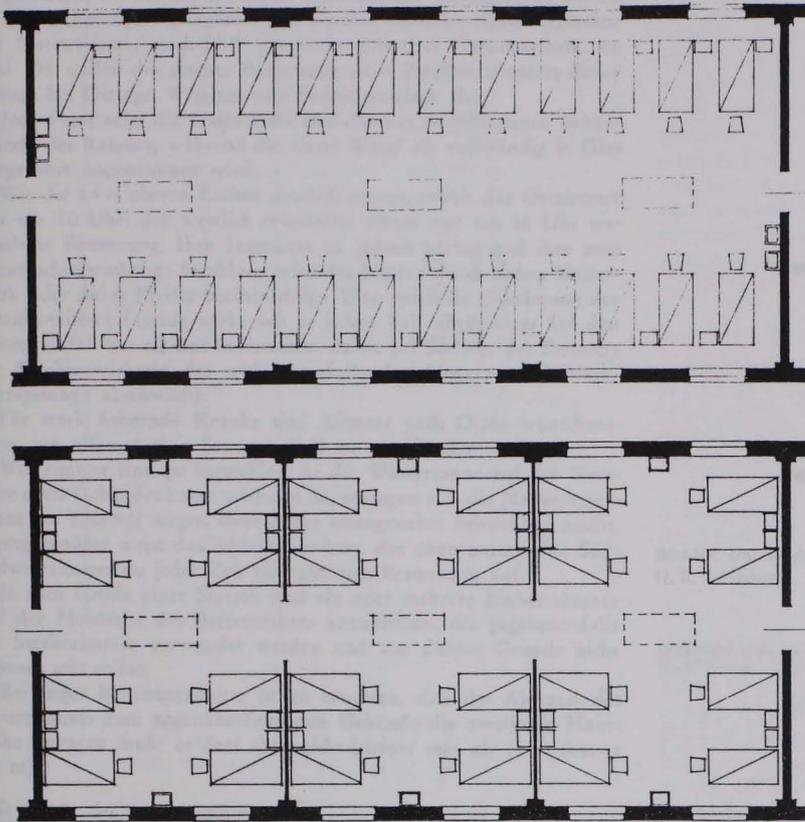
Schematische Grundrisse eines 24-Betten-Saales. Gegenüberstellung der Bettenanordnung im Perimeter-System (oben) und Rigs-System mit halbhohen Zwischenwänden
